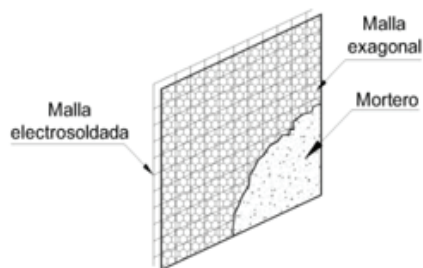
Sistema Ferrocemento, alma de malla electro-soldada revestida con malla hexagonal para adherencia y recubierta con hormigón ó mortero, según [ACI 549](#)
